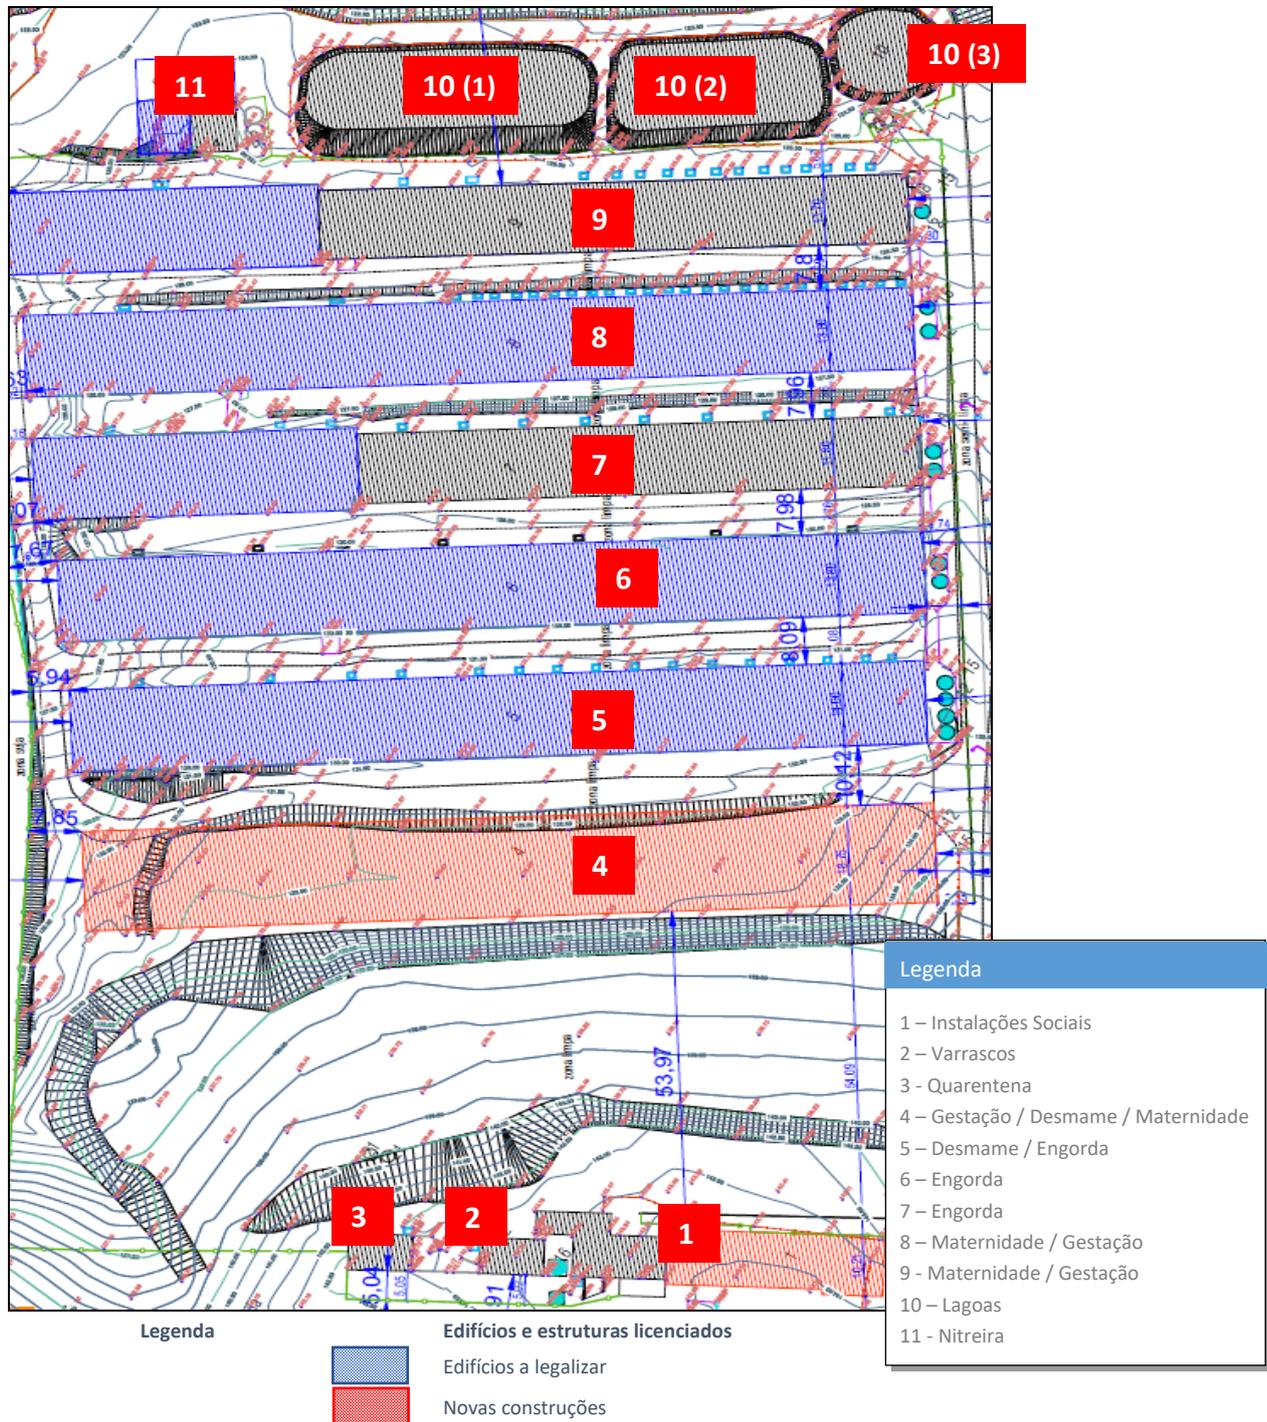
Planta de Implantação simplificada a partir do projeto de arquitetura
